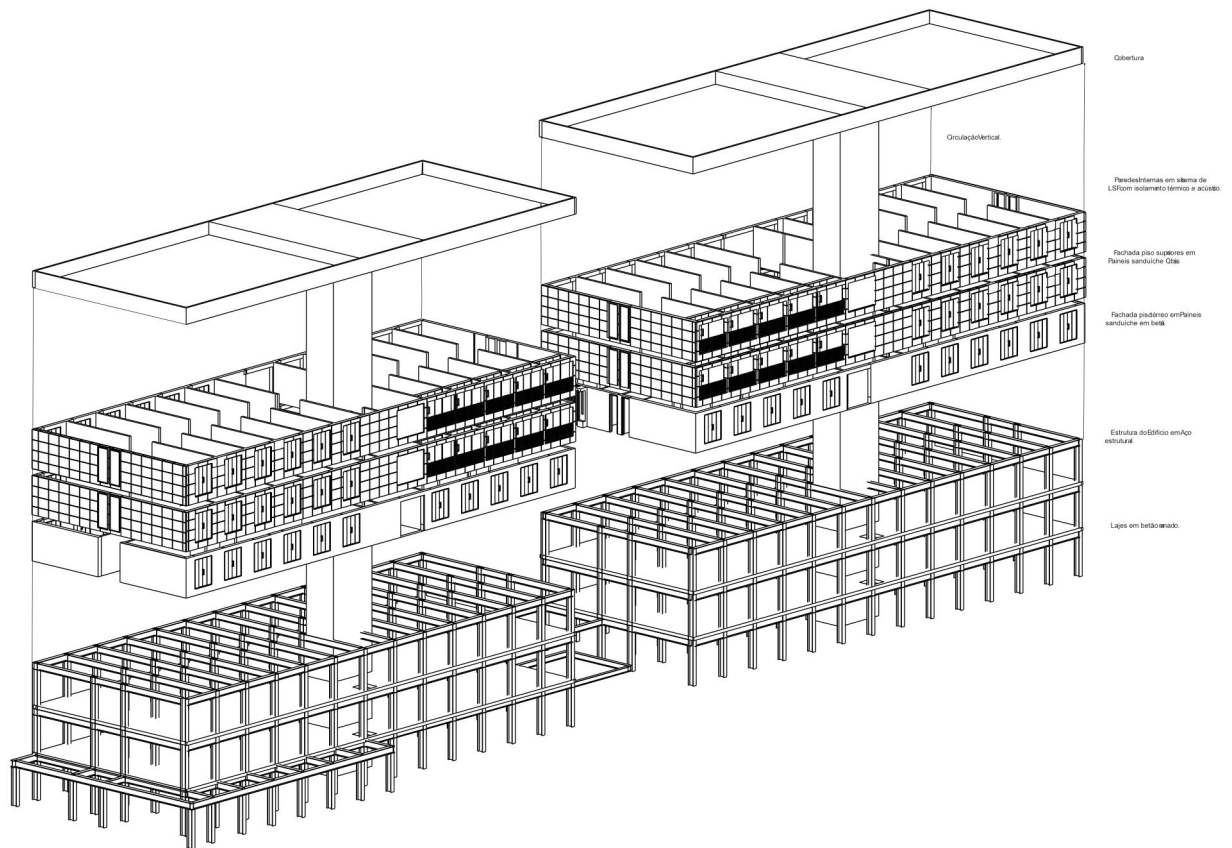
3D da Estrutura e Materiais Aplicados.
